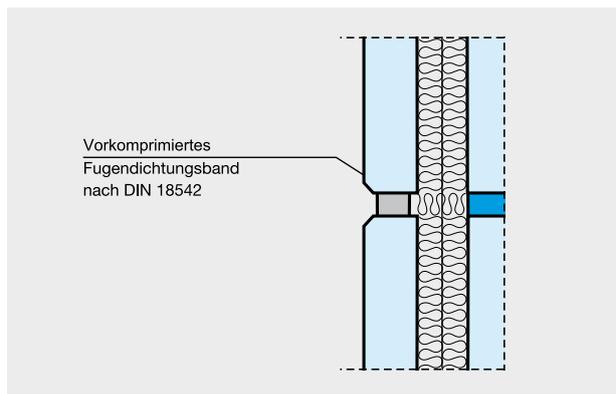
Horizontale Fugendichtung mit vorkomprimiertem Fugendichtungsband
